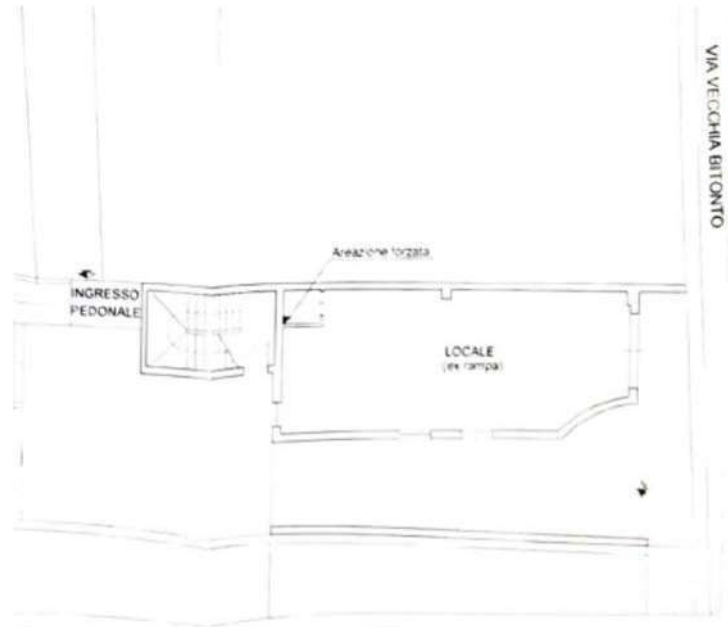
BENE H- Stralcio planimetria di progetto approvato P.d.C. n. 3389 del 23.12.2002 e
